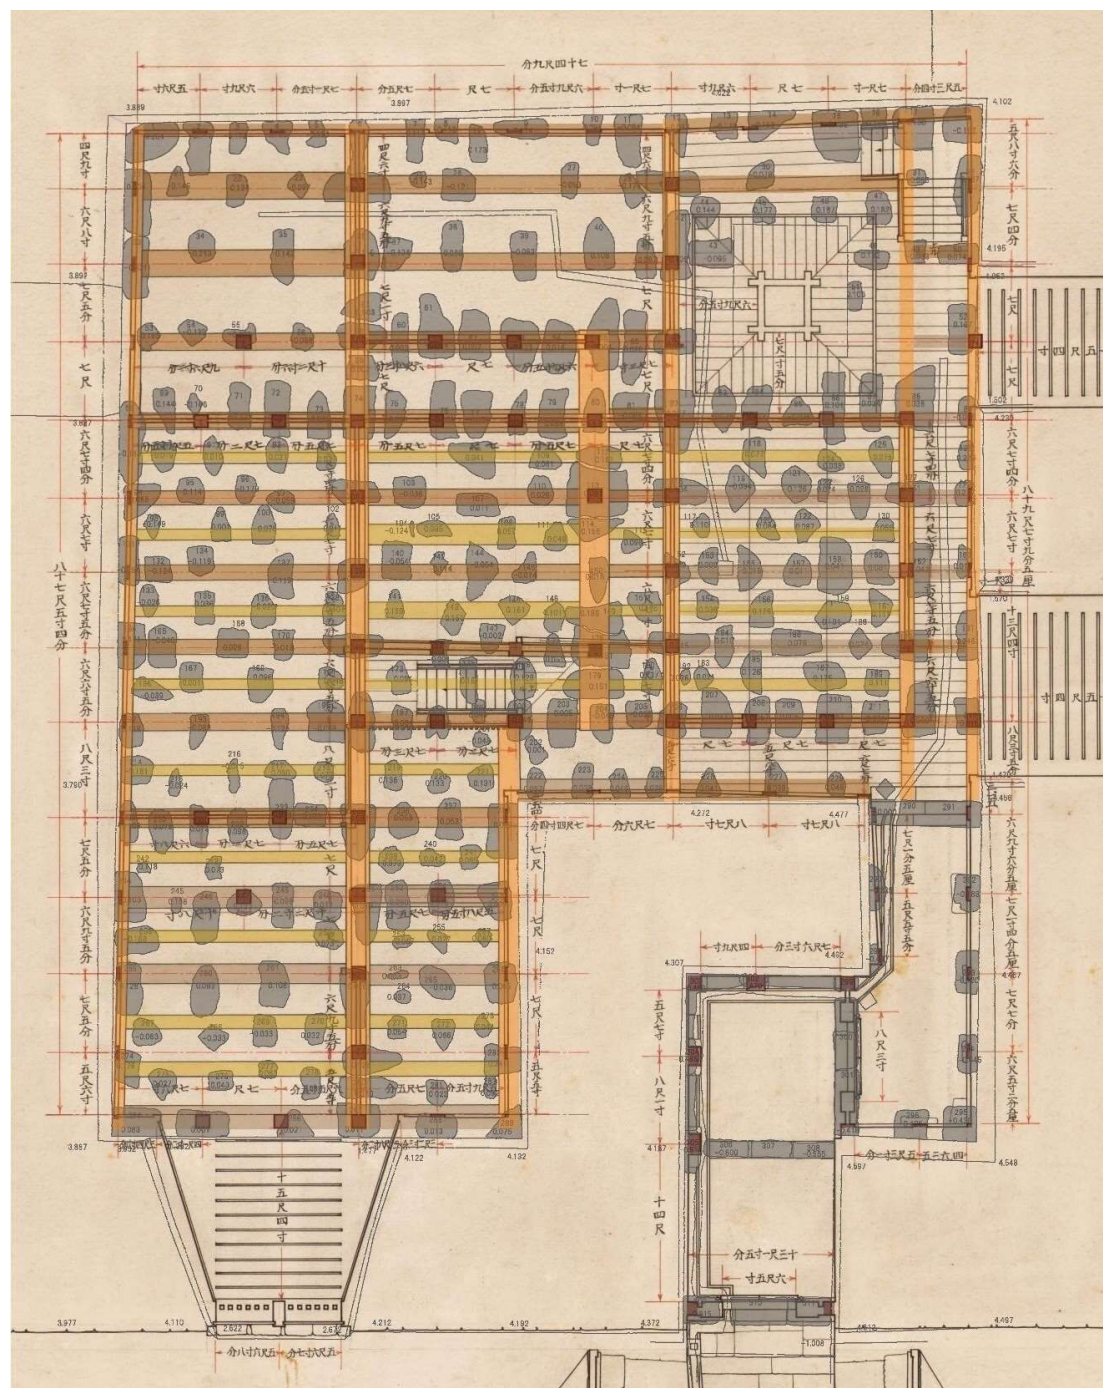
「天主礎石配置図」(名古屋城建設工事事務所作成 昭和32年)と昭和実測図「地階平面図」の重ね合わせ
